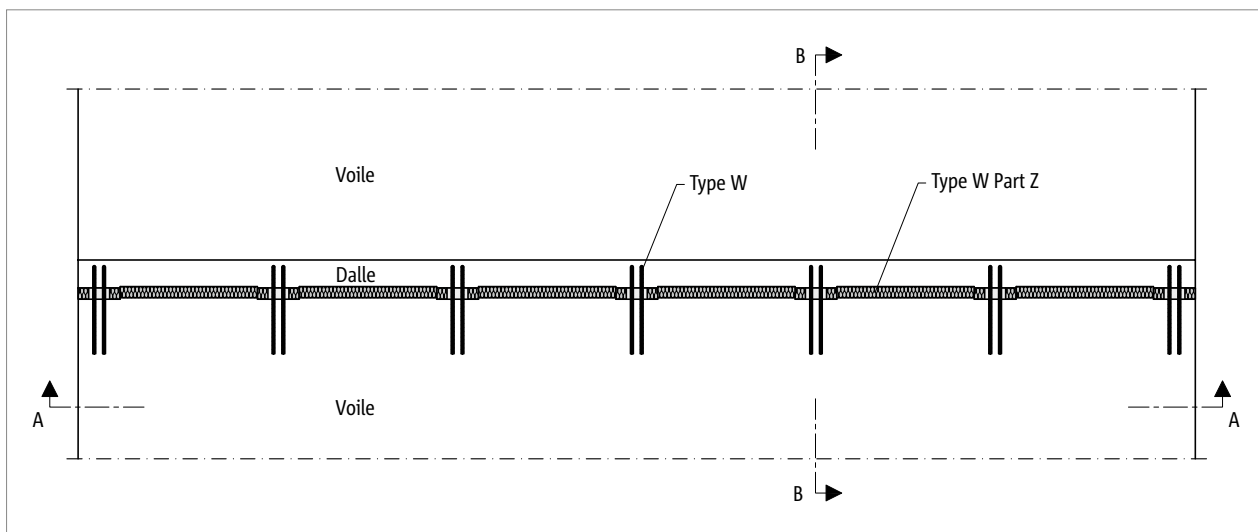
Schöck Sconnex® type W : raccordement entre le mur et la dalle sus-jacente - montage en tête de mur
